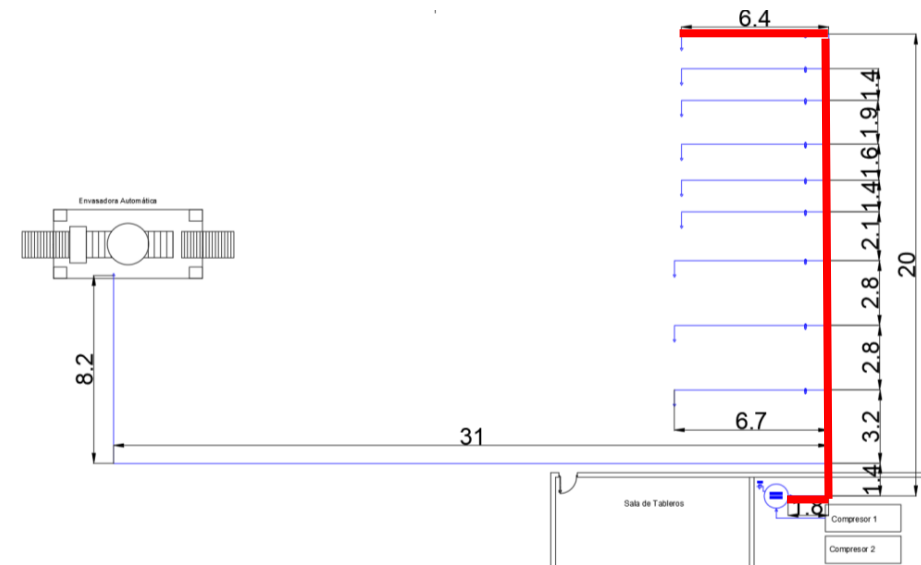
Layout verificación 11 de cañería de aire comprimido
